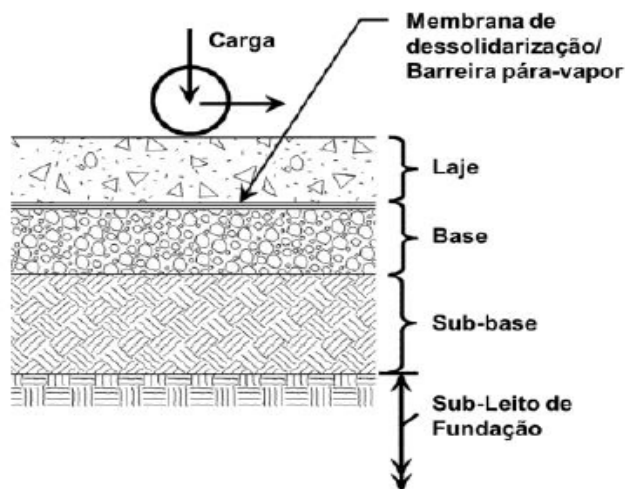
Estrutura de pavimento de betão, adaptado de [23].
